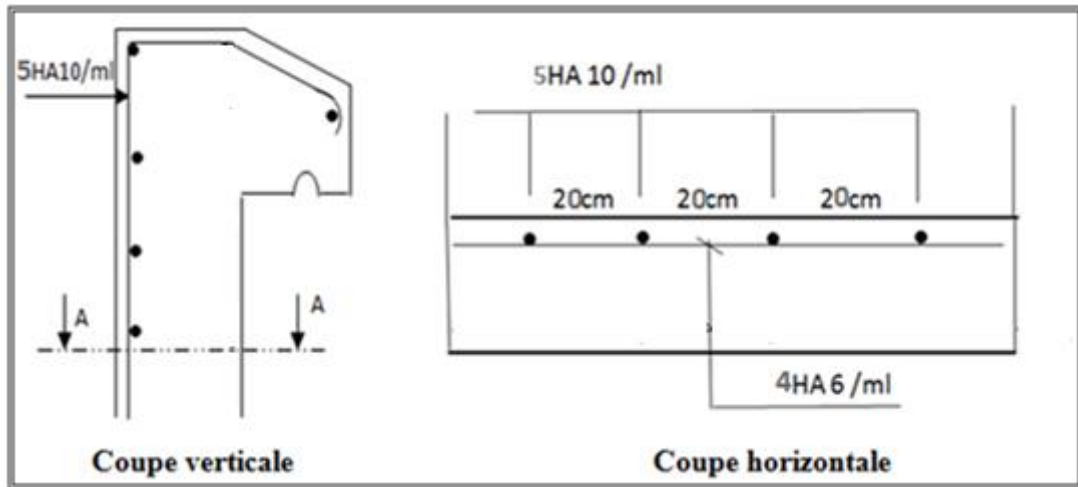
Schéma de ferrailage d'acrotère
